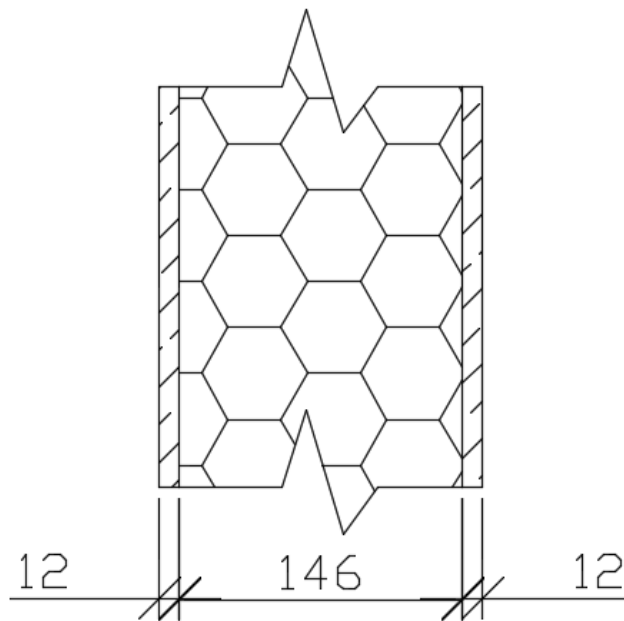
Схема конструкции стены надстраиваемого этажа.
